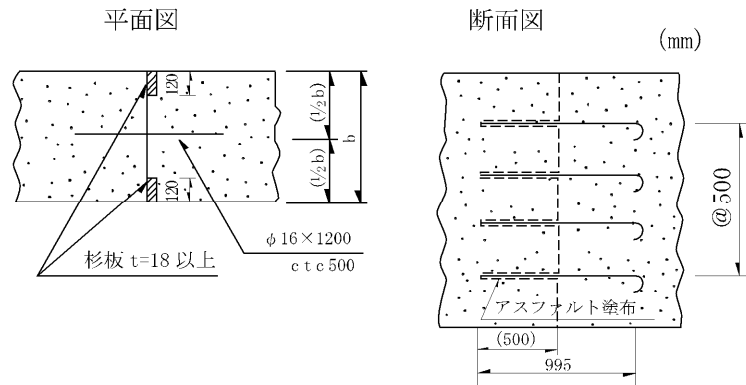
III-34 収縮目地の構造(無筋コンクリート擁壁)
